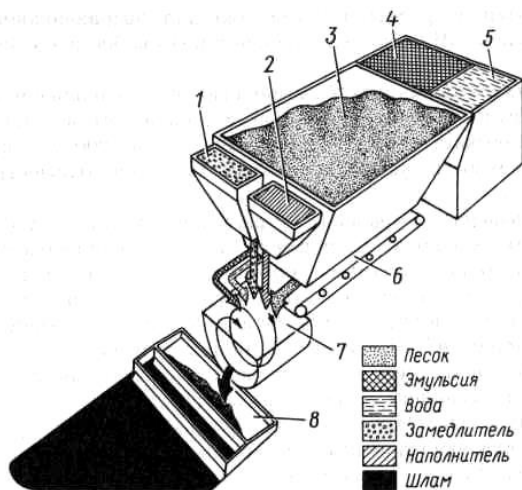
Компоновочная схема машины для приготовления и укладки шлама:
